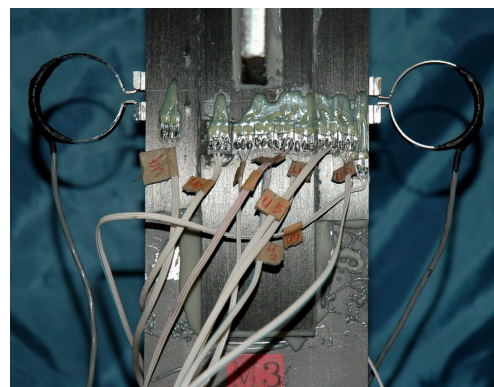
CFRP 板の接着状況 (M3 シリーズ)
